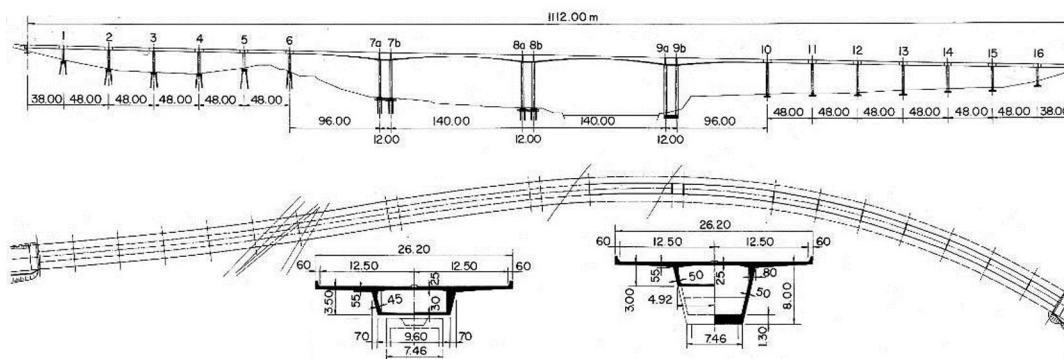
Felsenau-Brücke bei Bern - Längsschnitt, Grundriss und Querschnitte
